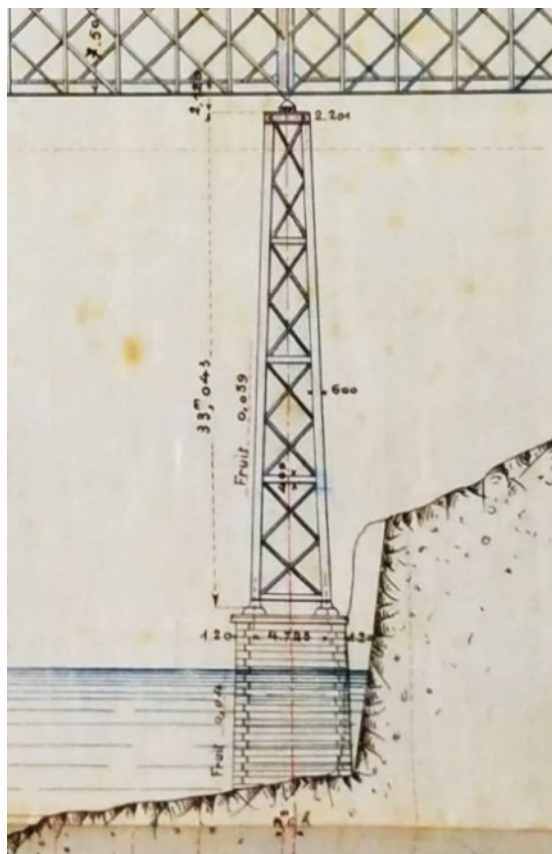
Pormenor de pilar metálico Ponte do Dão [4]
